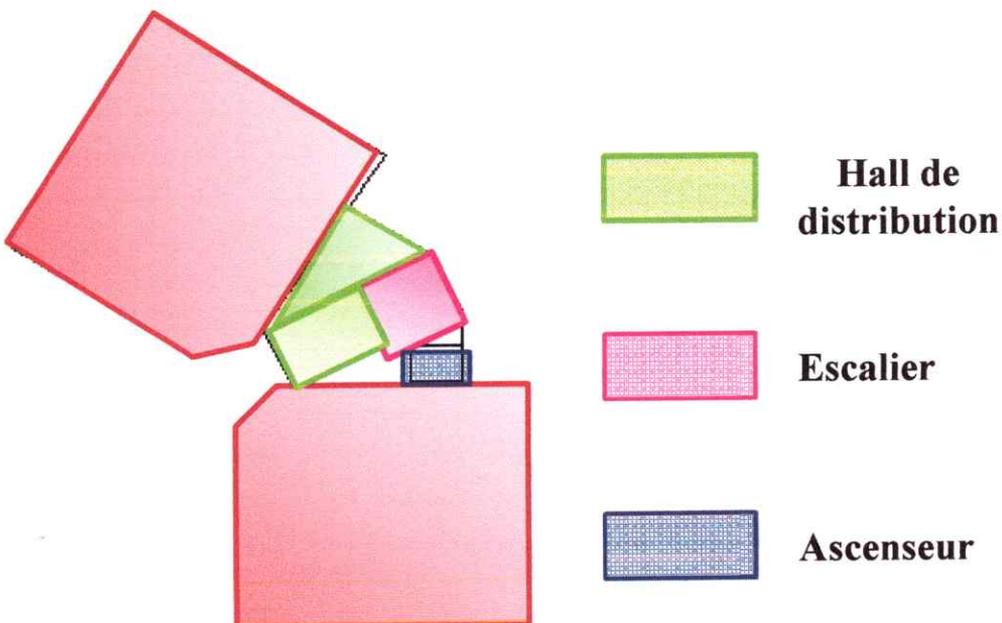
Plan (Angle) de REZ – DE –CHAUSSE
